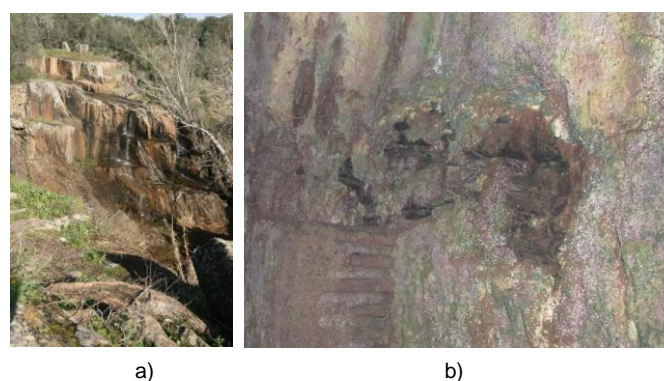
a) Escorrências observadas junto ao encontro esquerdo e b) erosão do reboco e decomposição da argamassa no interior da construção (retirado de Tetraplano, 2002).
